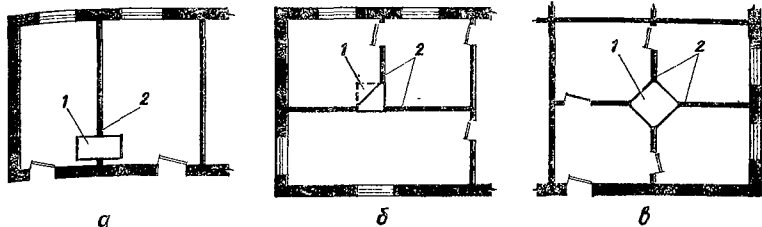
Размещение печи в проеме внутренней стены или в перегородках для отопления смежных комнат:
